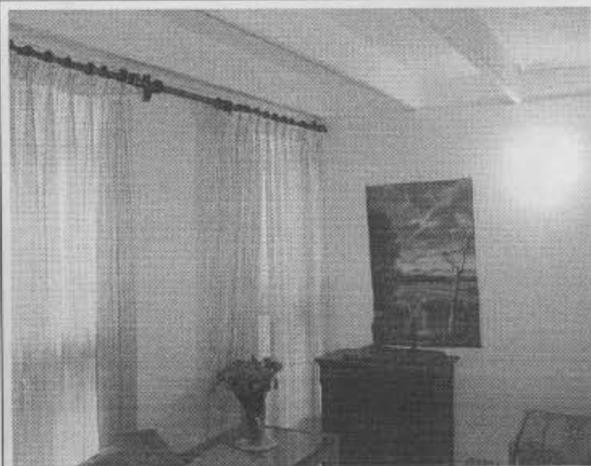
Vista interna de primer piso, sin daños estructurales apreciables.
